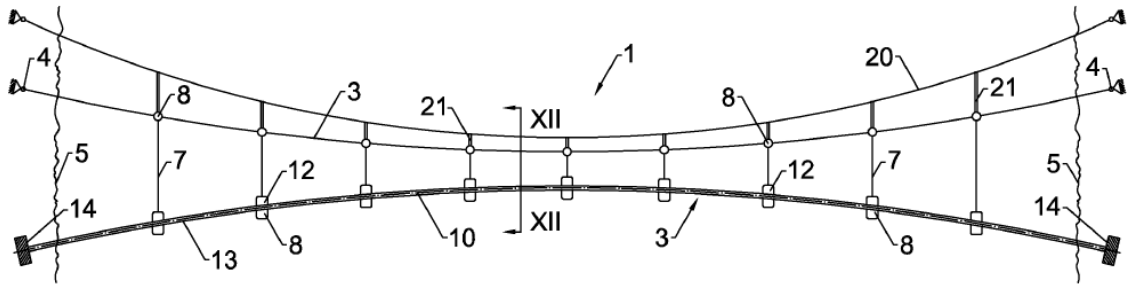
Grundriss, Variante 3 (Kollegger, et al., 2015)
